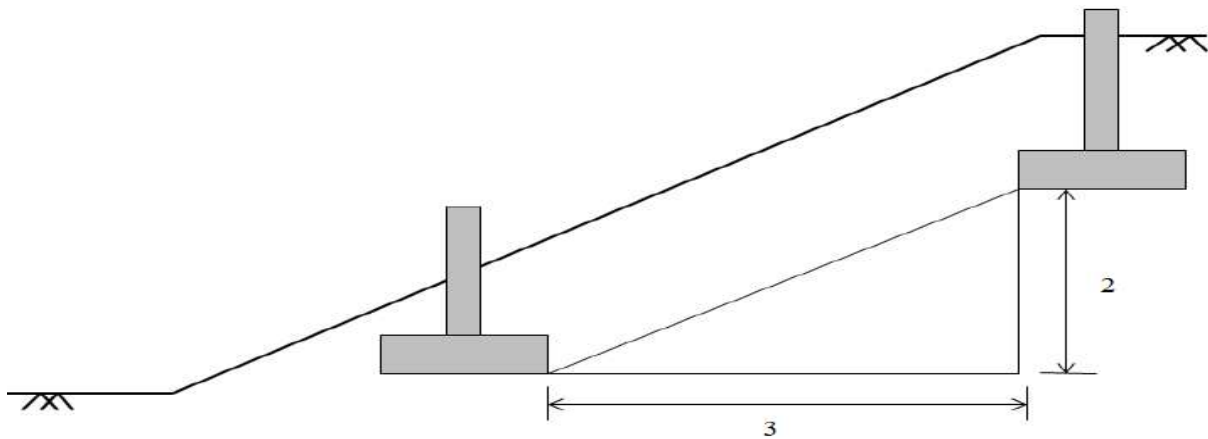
Pente limite pour les fondations sur un sol en pente
